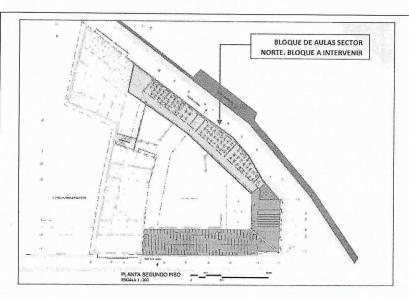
Planta arquitectónica general del segundo piso. Fuente: Archivo personal.
